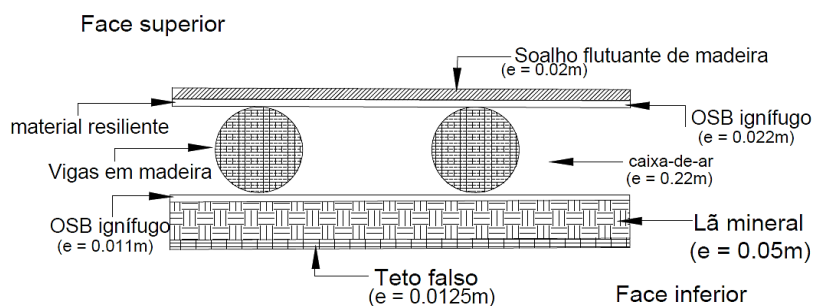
Esquema estrutural da solução de melhoria do pavimento entre habitações PV01.
